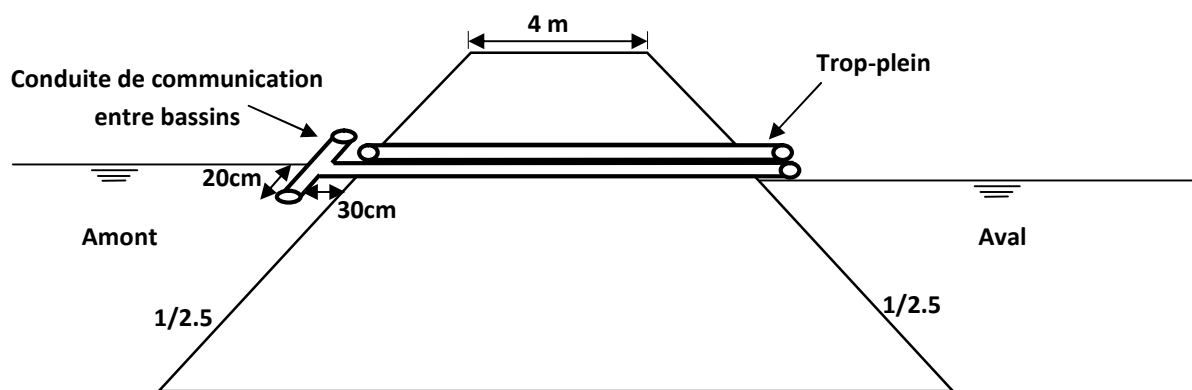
Disposition de la conduite de communication et le trop-plein
